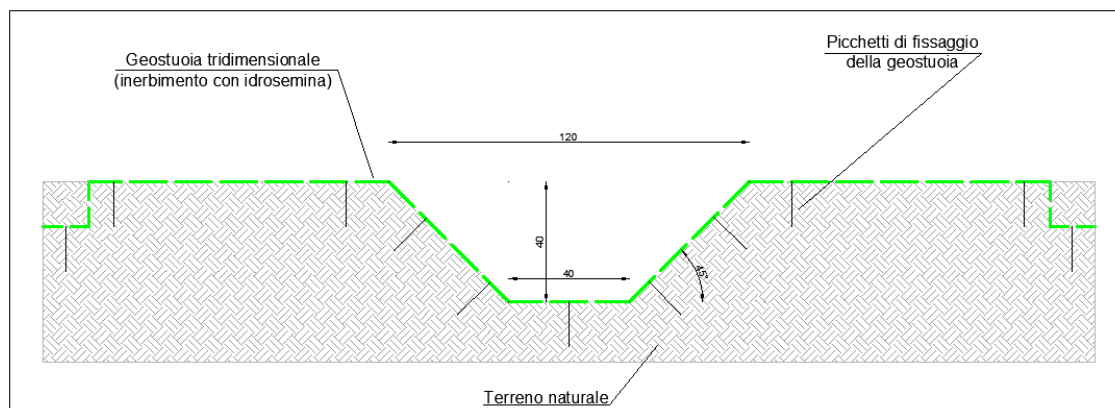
Sezione di drenaggio - Canale trapezoidale in terra
